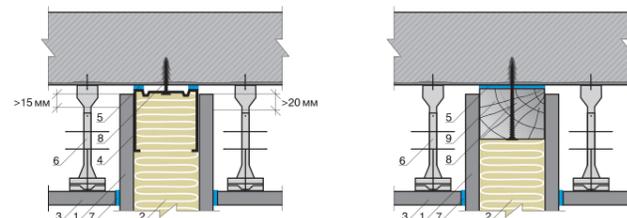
Схема крепления двухслойной обшивки из ГКЛ к стойкам каркаса
